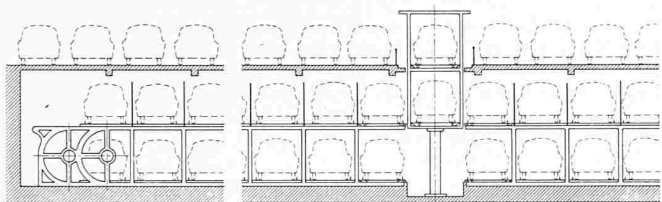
Konstruktionstyp für einstöckigen Unterflurbau
